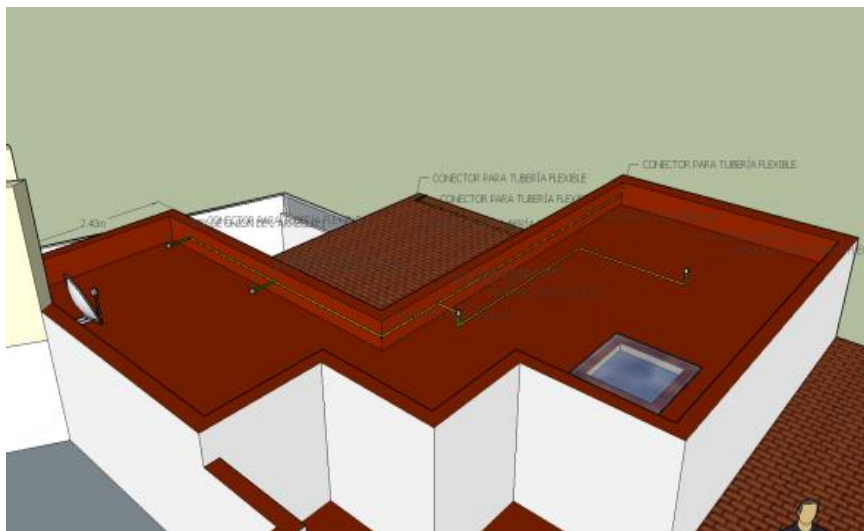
Plano 3D de Ruta de tubería, vista 1: aporte propio.
